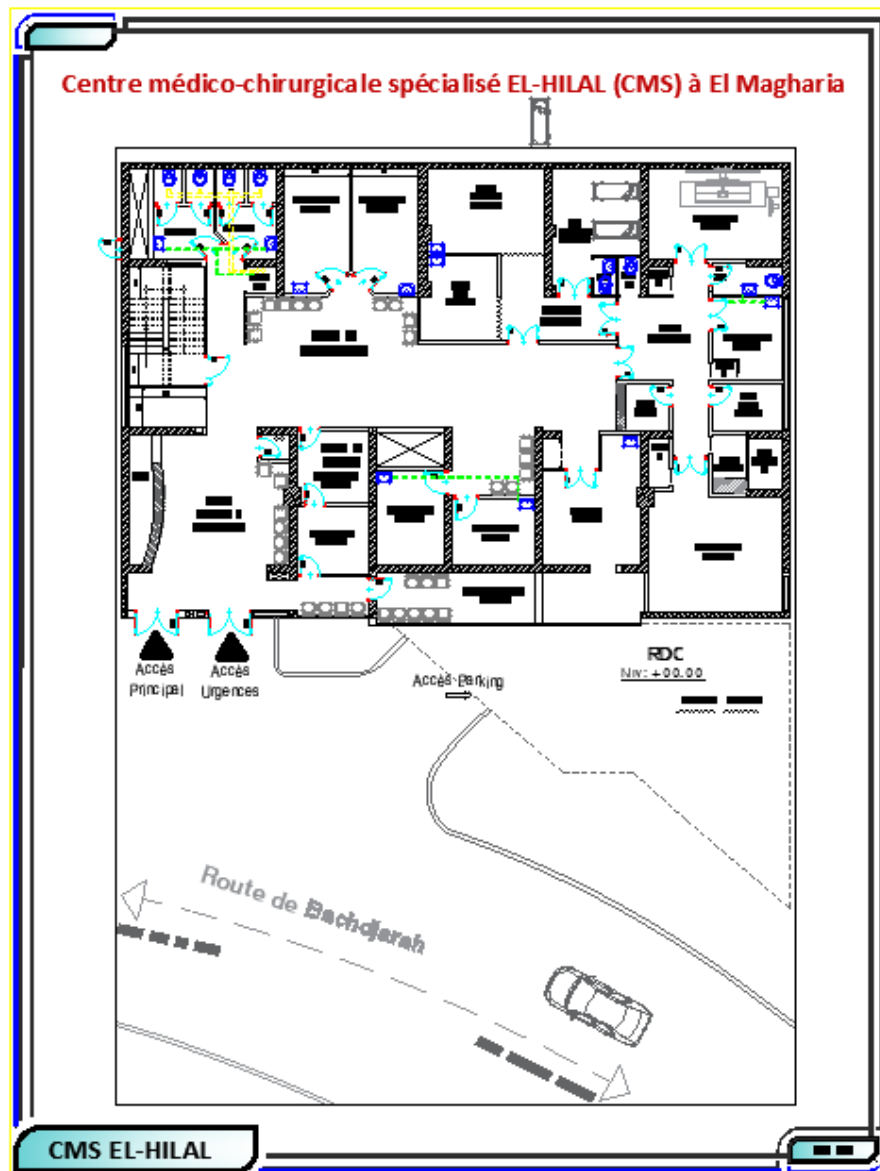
Plan AutoCAD du rez-de-chaussée de la clinique EL-HILAL.
